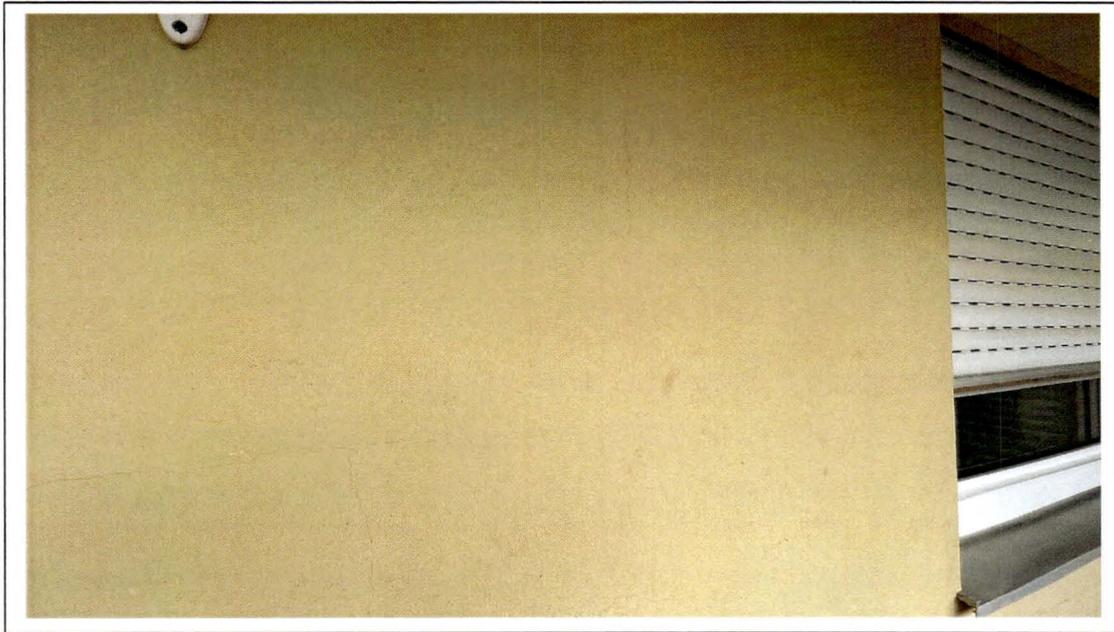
Hauswand (in der Loggia-Nische) mit Rissen
